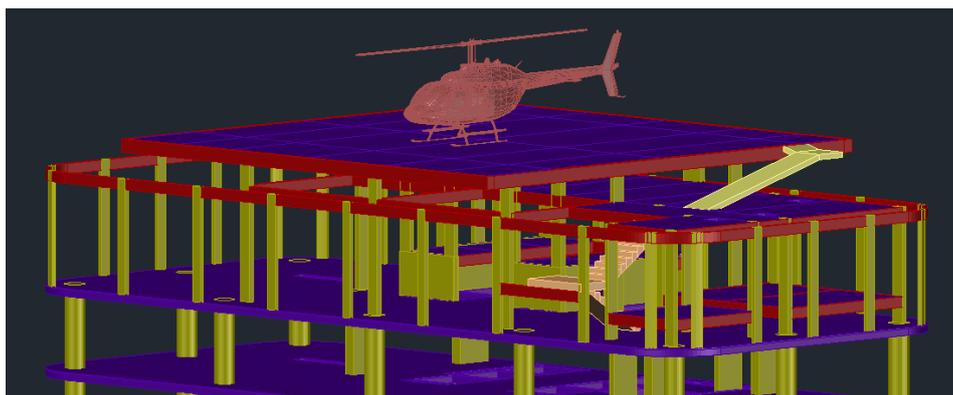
Características estruturais do heliponto inspeccionado em 3D
